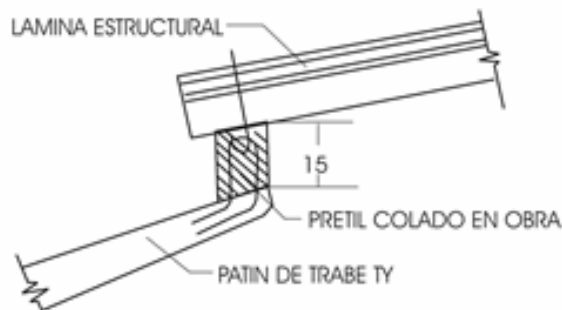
Detalle de apoyo de trabe TY. Apoyo de la lámina
